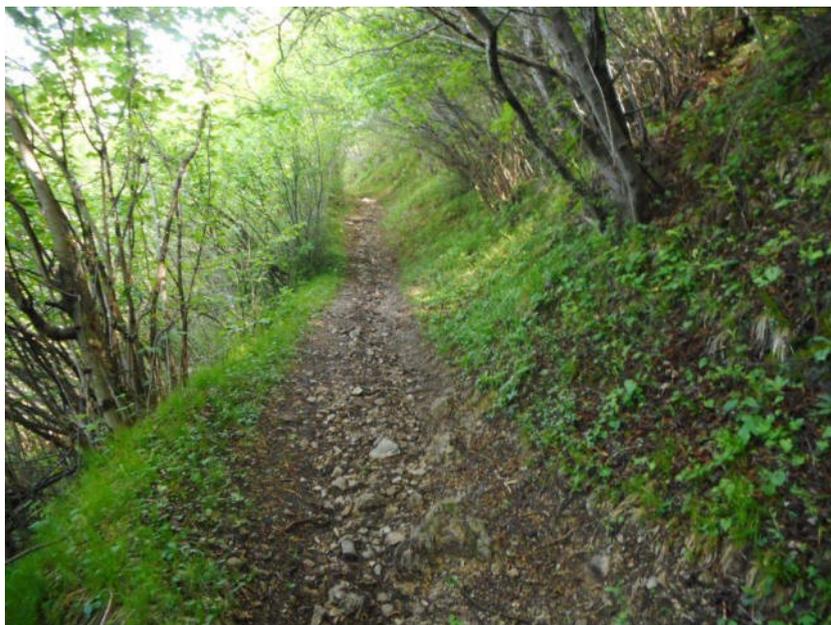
Primo tratto della Pista in progetto soggetta ad allargamento sul sentiero esistente
